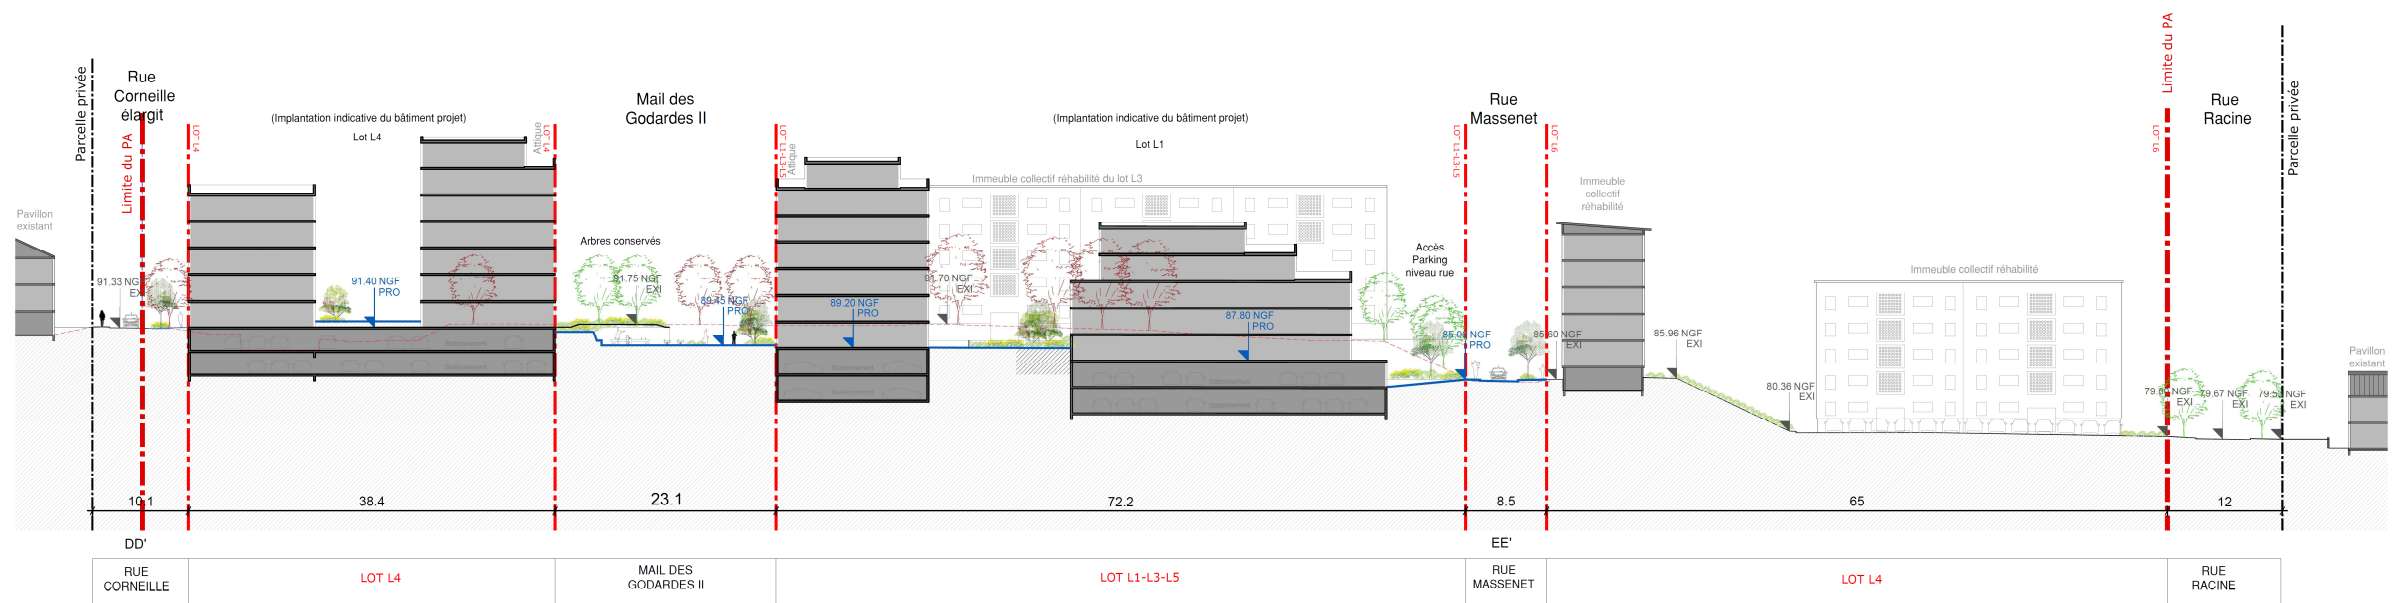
Coupe Ouest-Est de l'existant et du projet. Source : CPAUPE
